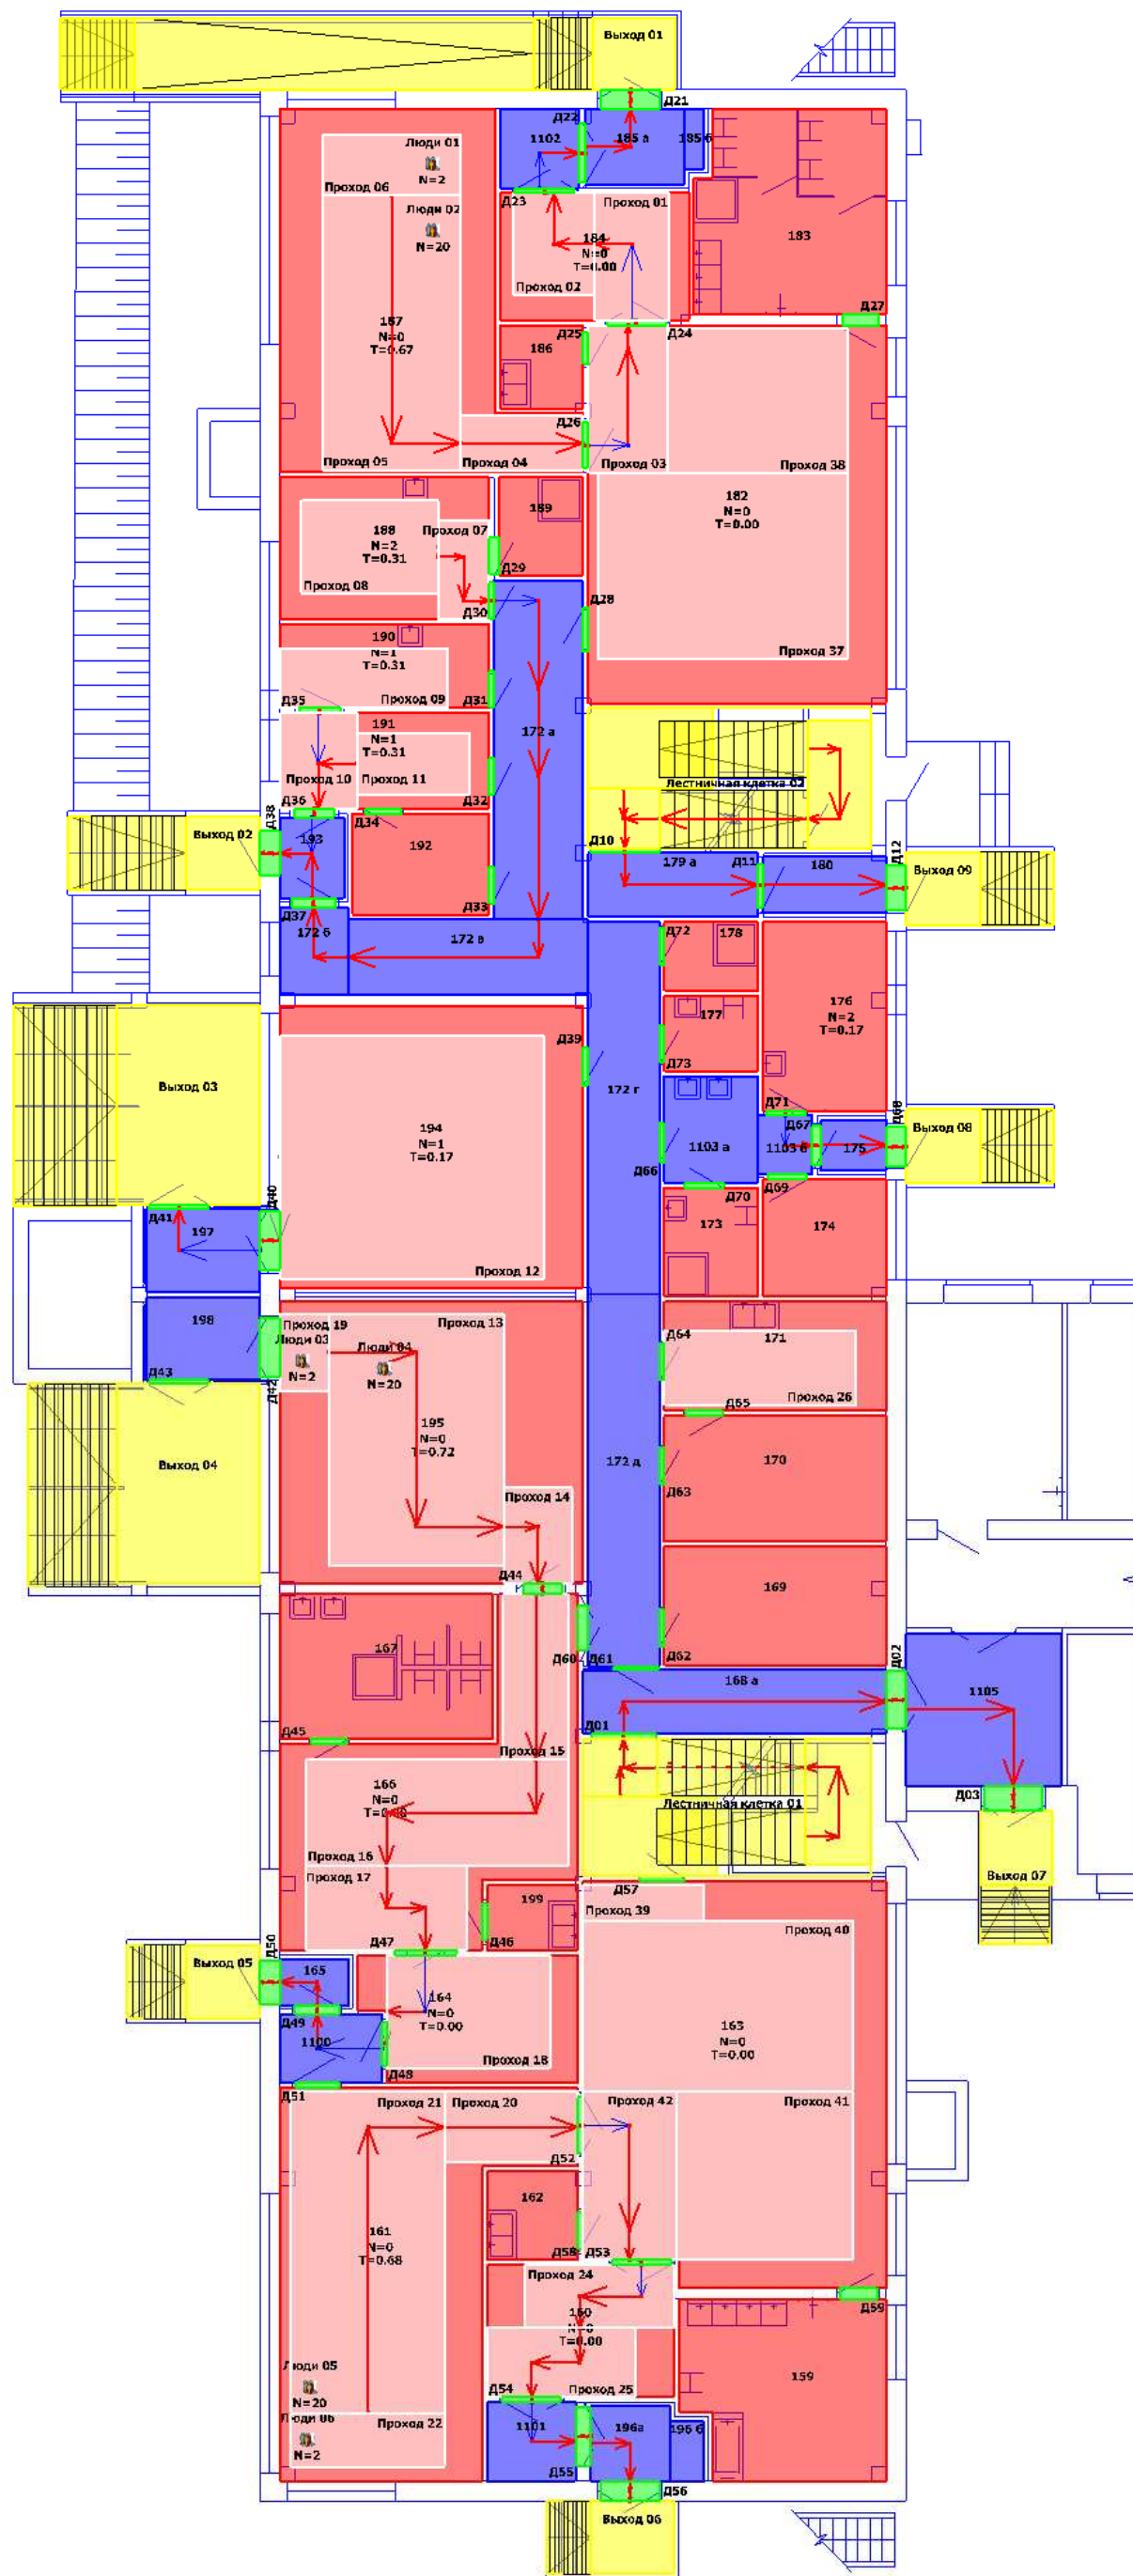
Расчетная схема эвакуации из помещений 1-го этажа здания Детского сада на 60 мест с начальной школой на 100 учащихся (Сценарий 01)
